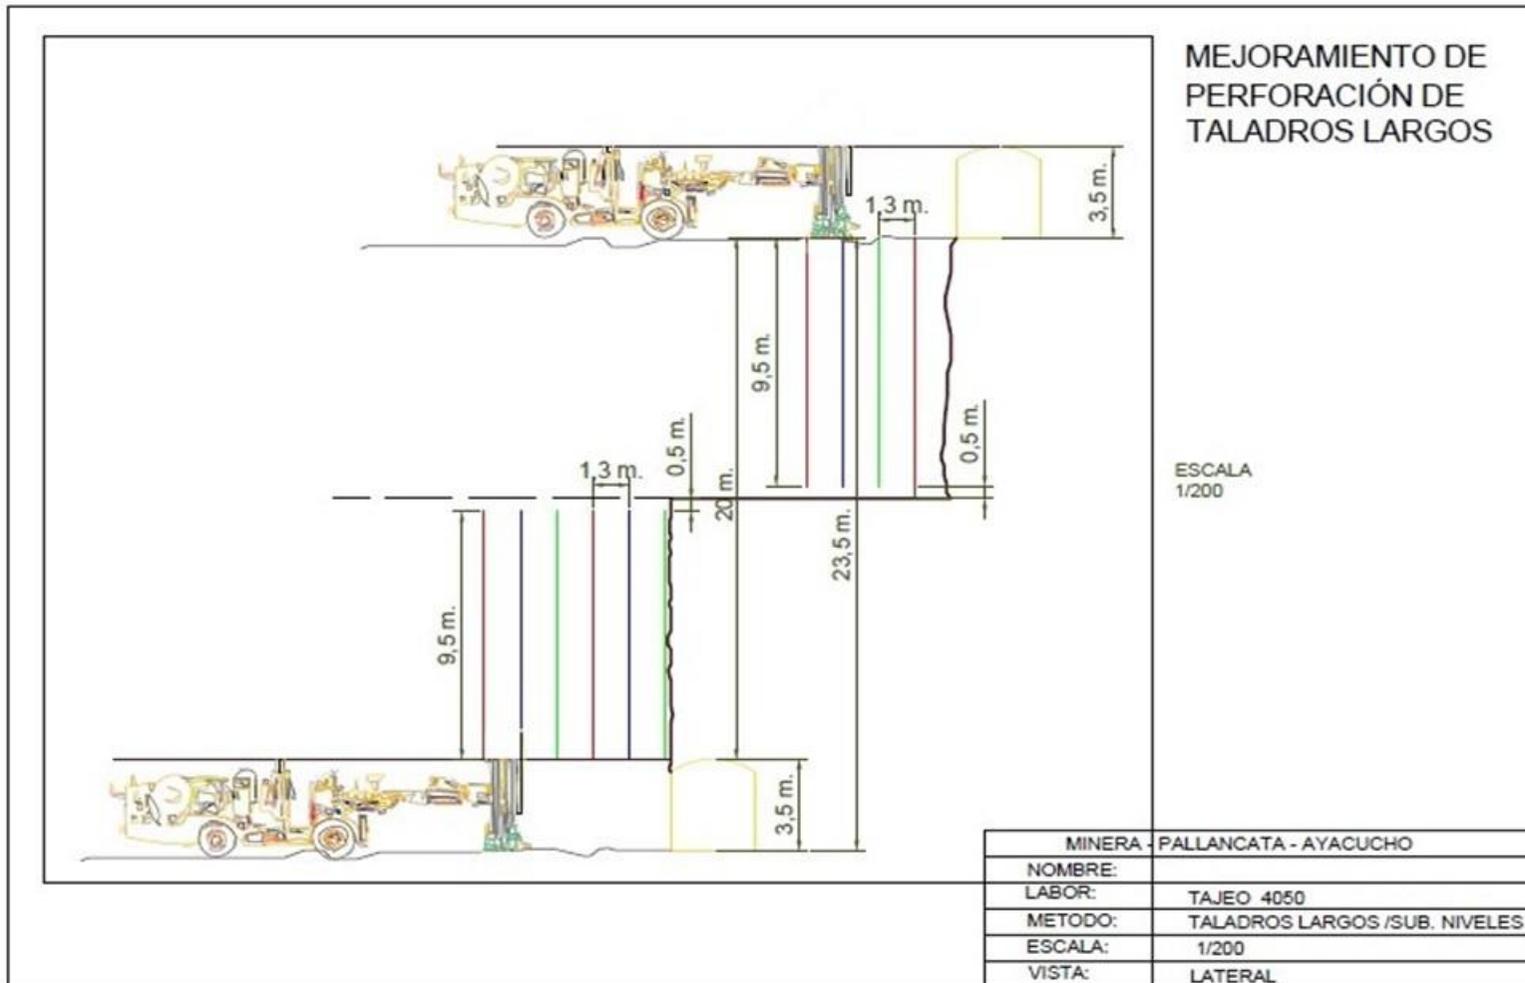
Plano vista de lateral – Propuesta de Mejoramiento.
